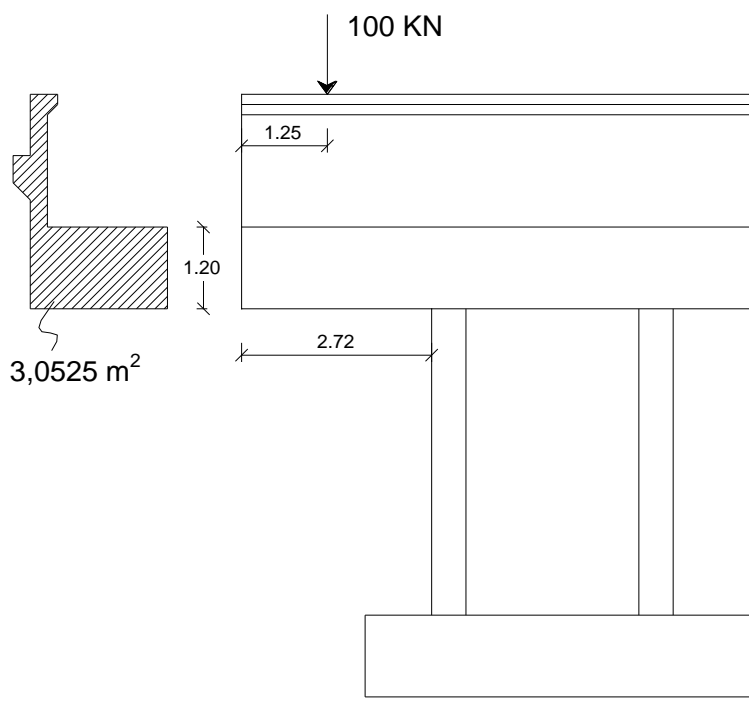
Acção do Veículo Tipo sobre a Viga de Estribo do Encontro E1
